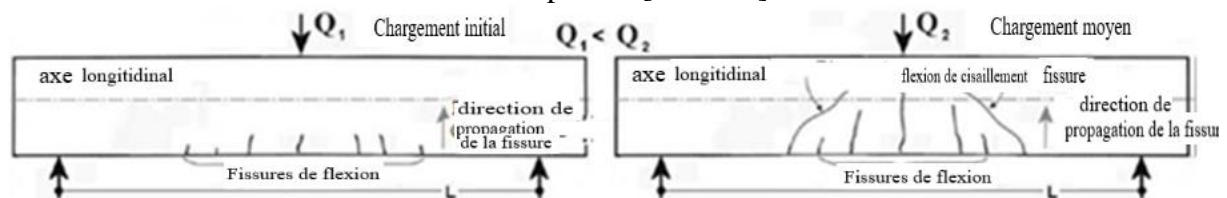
Représentation de la fissuration initiale et intermédiaire par flexion d'une poutre en béton armé (BA). [CRO 06]
